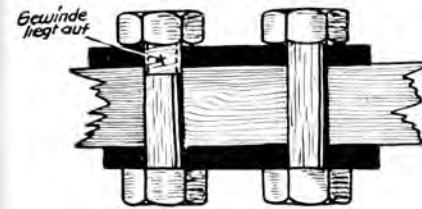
Gewinde des linken Bolzen liegt tragend auf.
